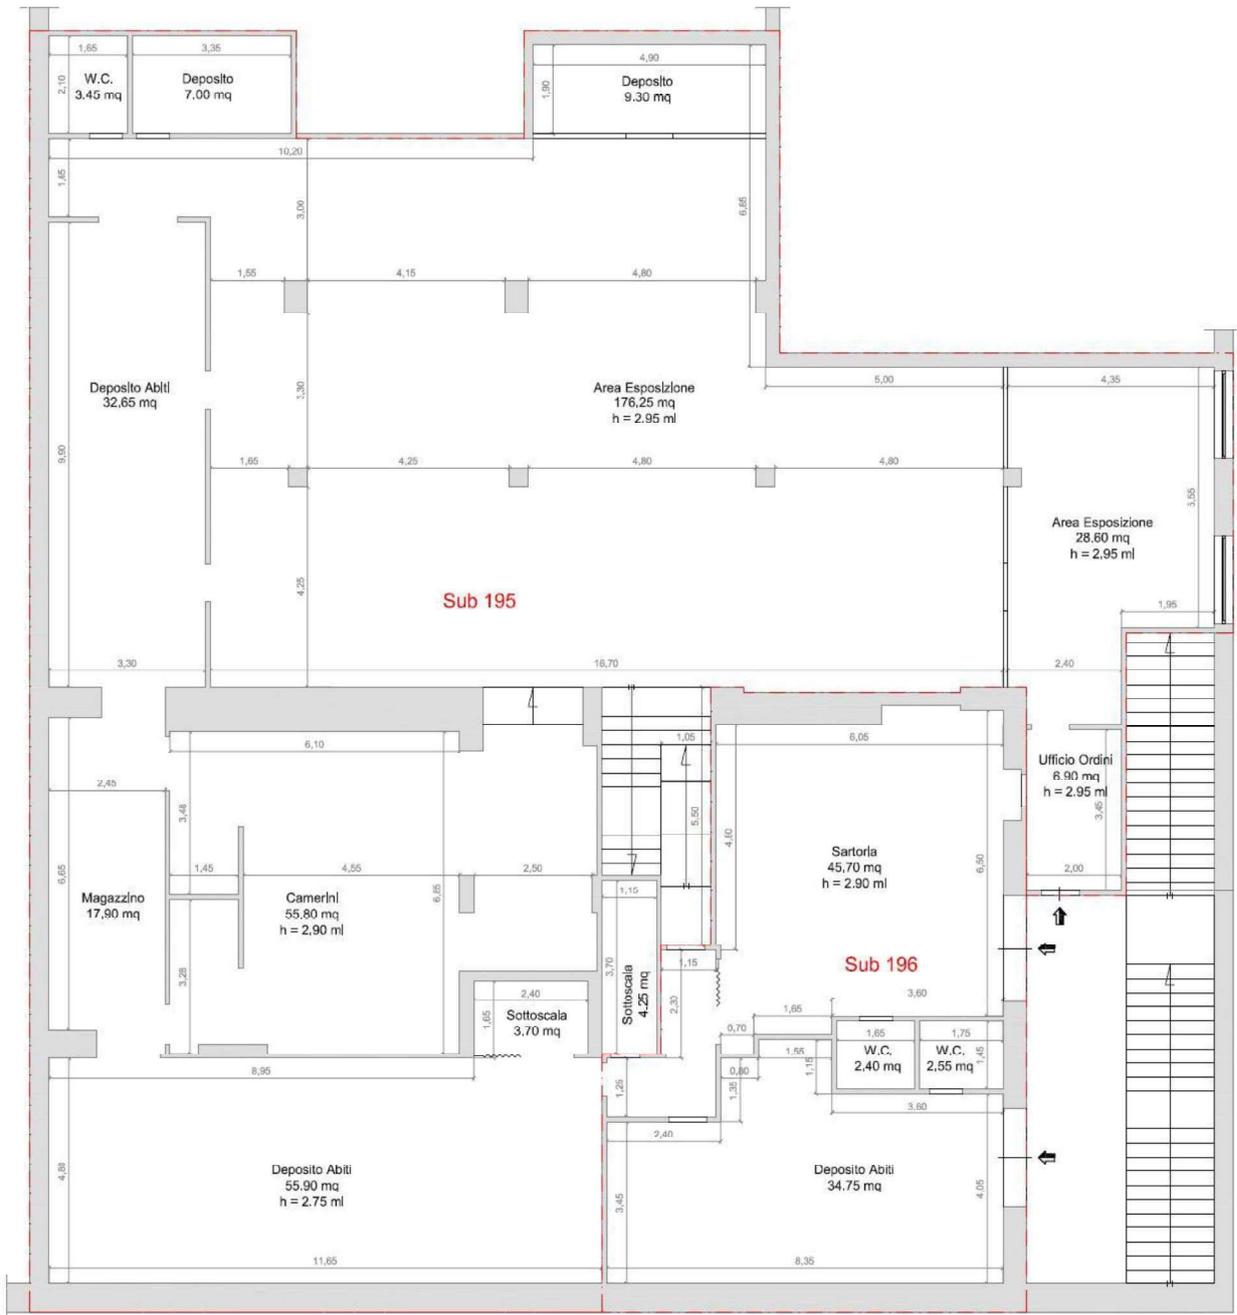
Planimetria Stato di Fatto Piano Seminterrato, Foglio 48, p.lla 76, Sub 195-196 (Ex Sub 1).
